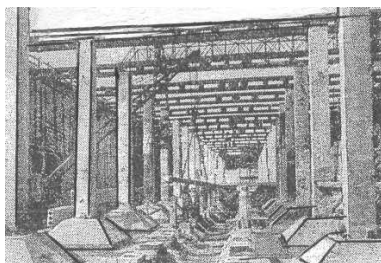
Монтаж сборных железобетонных конструкций при строительстве станций Киевского метро
